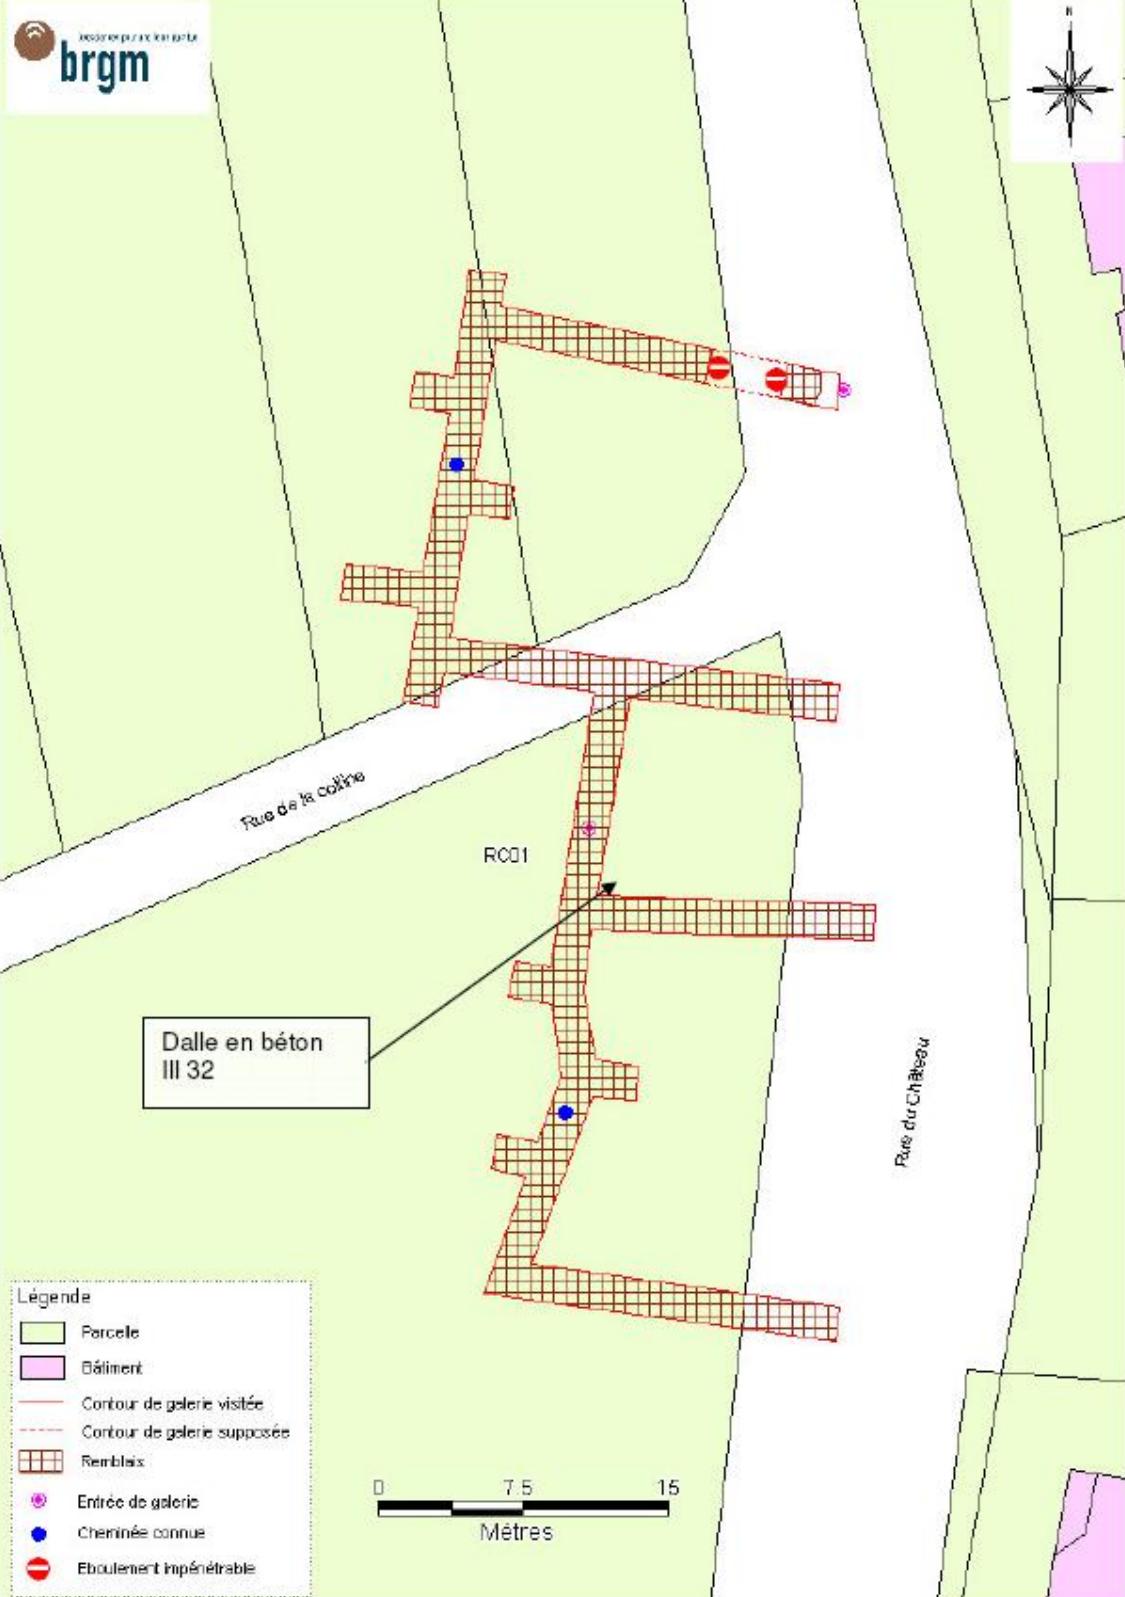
Plan des galeries souterraines situées rue du Château.
